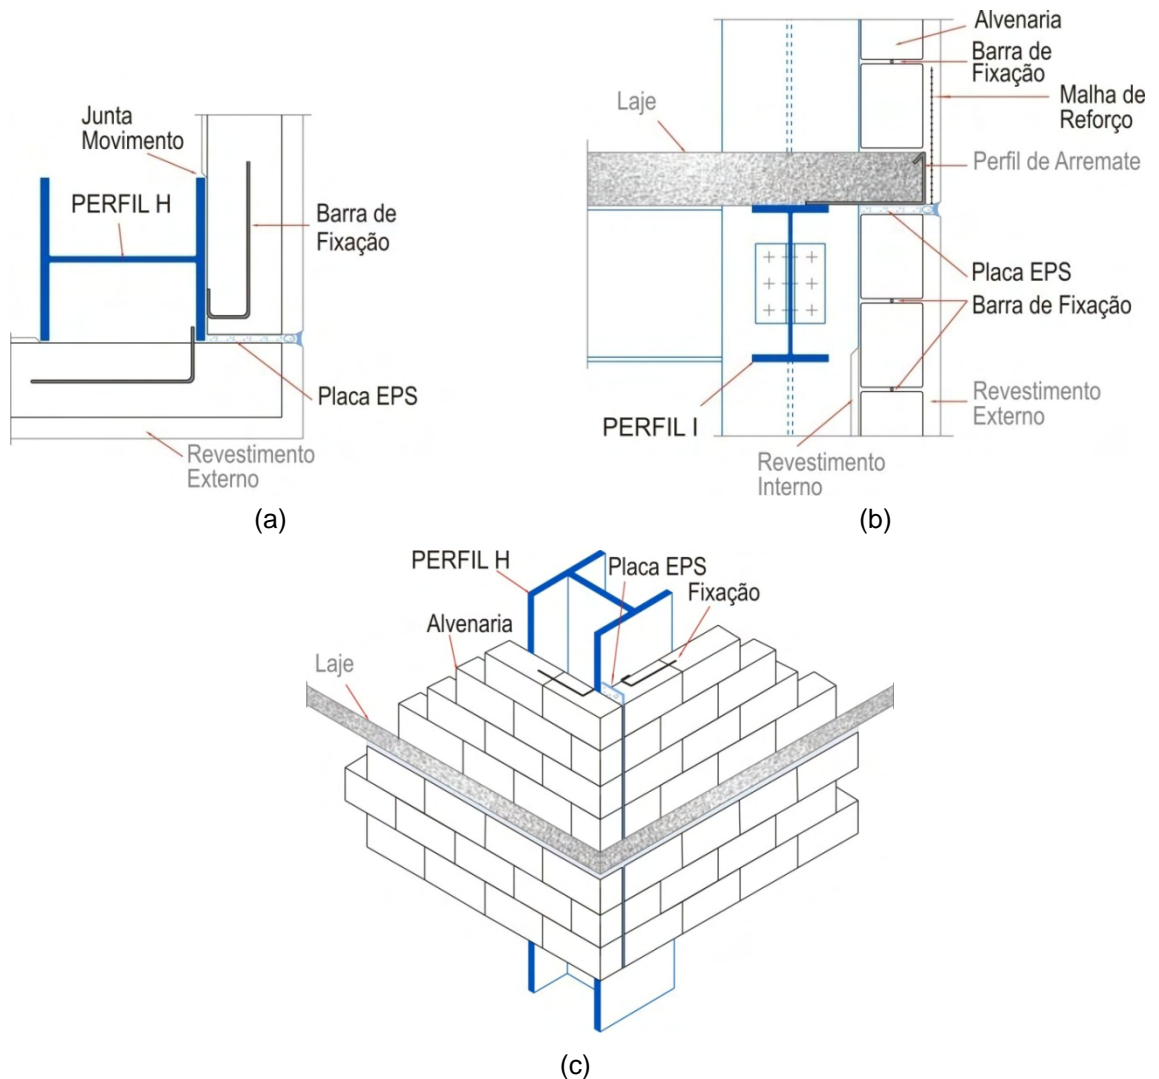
Esquema de fechamento em alvenaria externo à estrutura. (a) Planta; (b) elevação; (c) perspectiva (Adaptado de COELHO, 2004).
